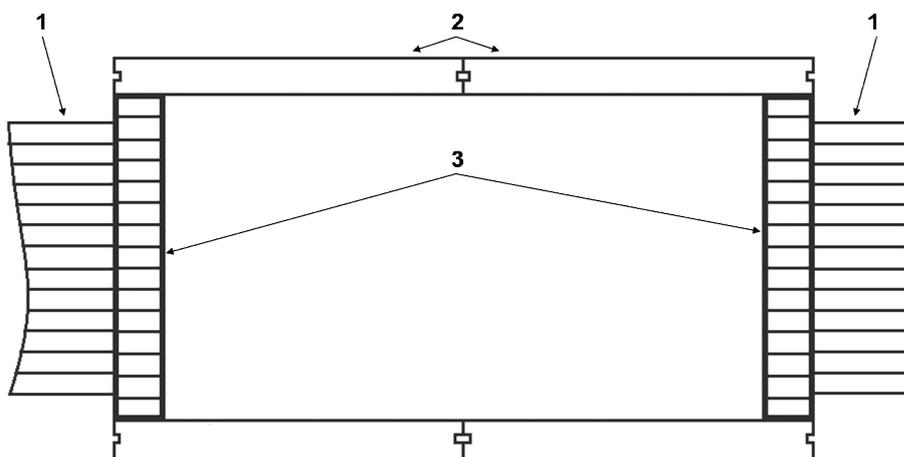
Кирпичные торцевые стены в колодцах типа «ККС», вид сверху на колодец «ККС-1» без плит покрытия:
